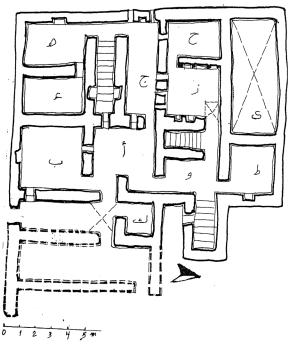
منزل القاضي عمر الدور الأرضى - مسقط أفقى
